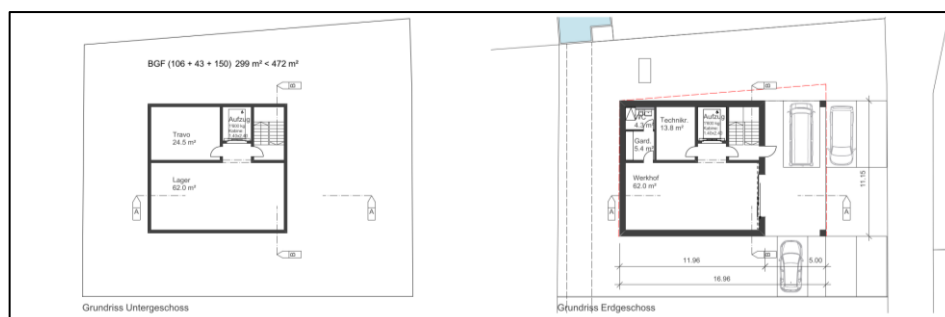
Grundrisse Untergeschoss und Erdgeschoss, Vorprojekt V1,
